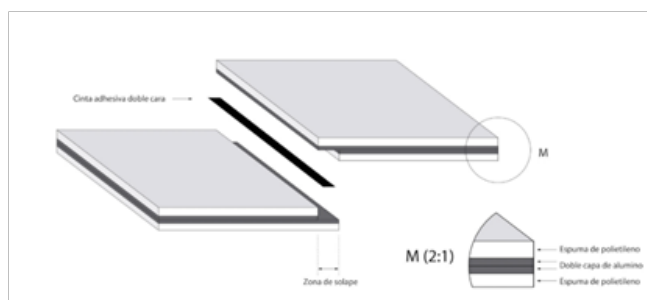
Detalle constructivo solución solera/suelo con Tripomant).
